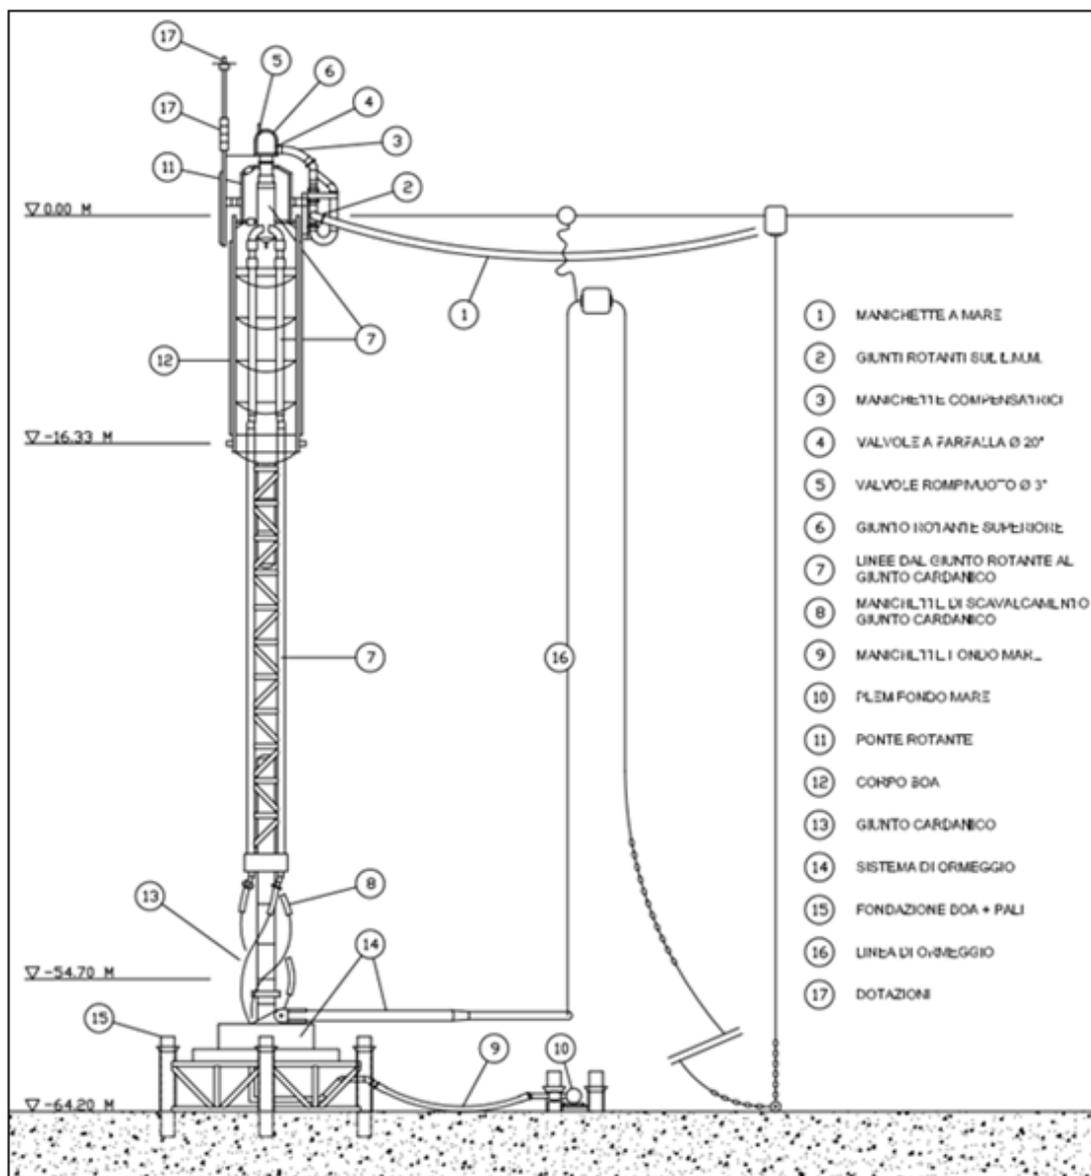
Vista della Monoboa, della Fondazione e del PLEM
